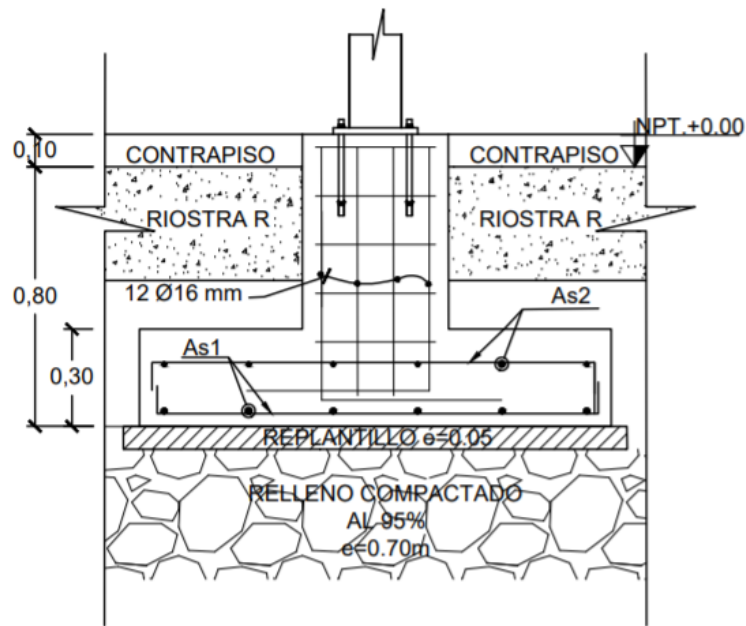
Detalle de la zapata aislada, dado, placa base, pernos de anclaje y columna metálica (Segura, A., Vélez, F., 2020).
